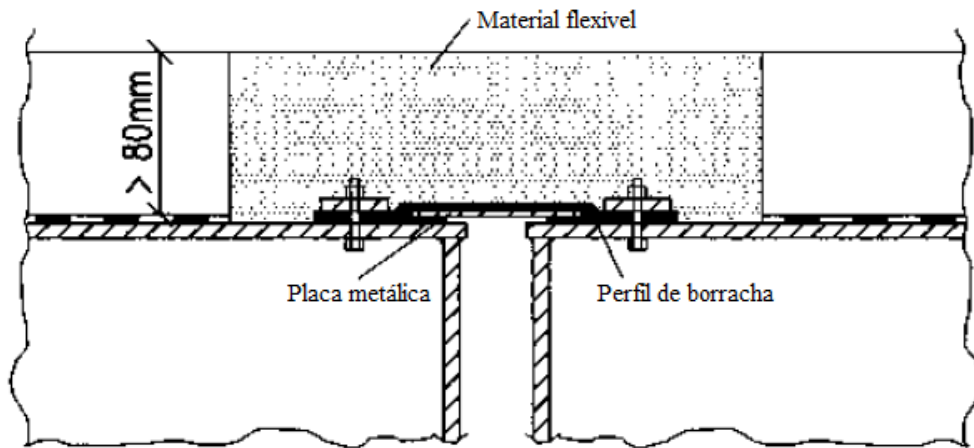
Junta de dilatação de betume modificado com um perfil de borracha [5]
